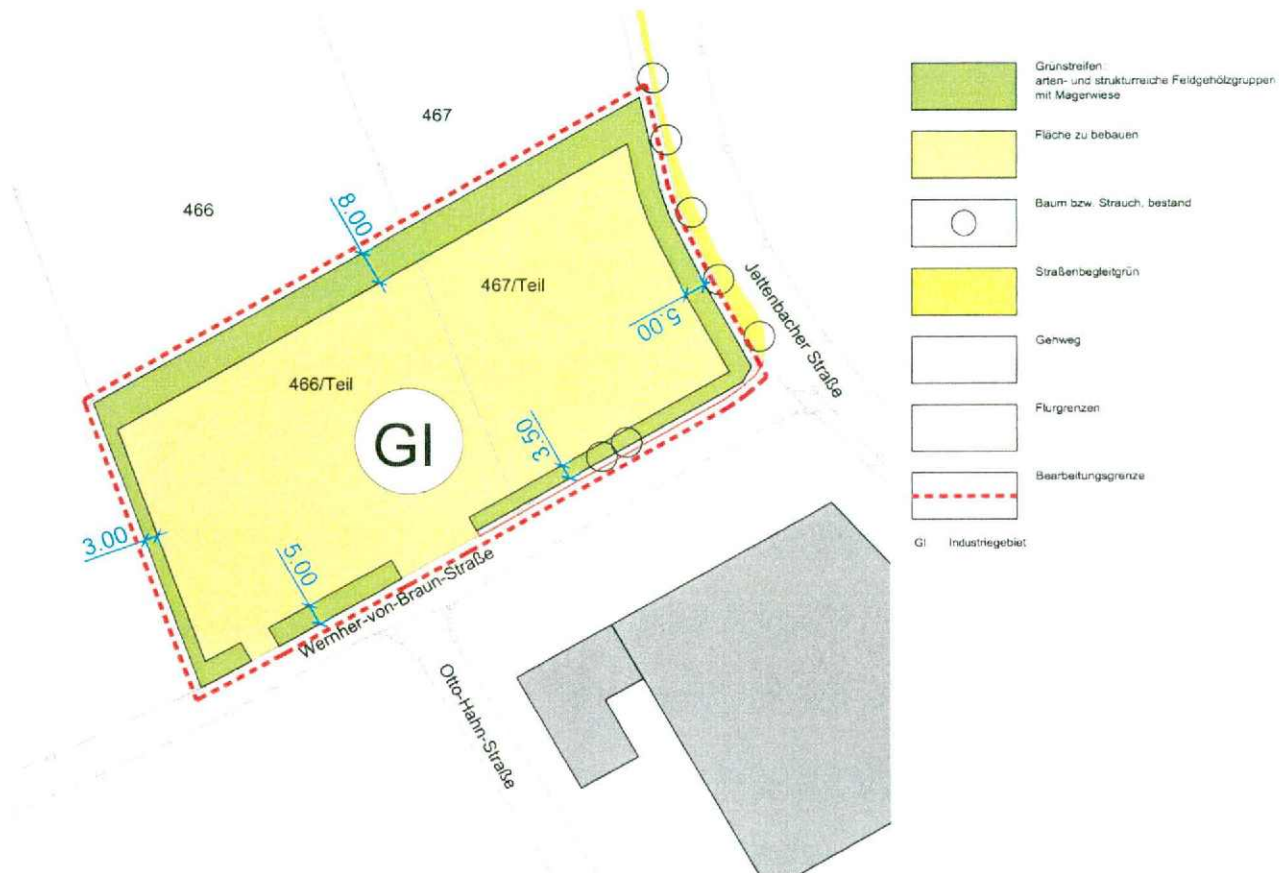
Bebauungsplan Industriegebiet „Otto-Hahn-Straße“
